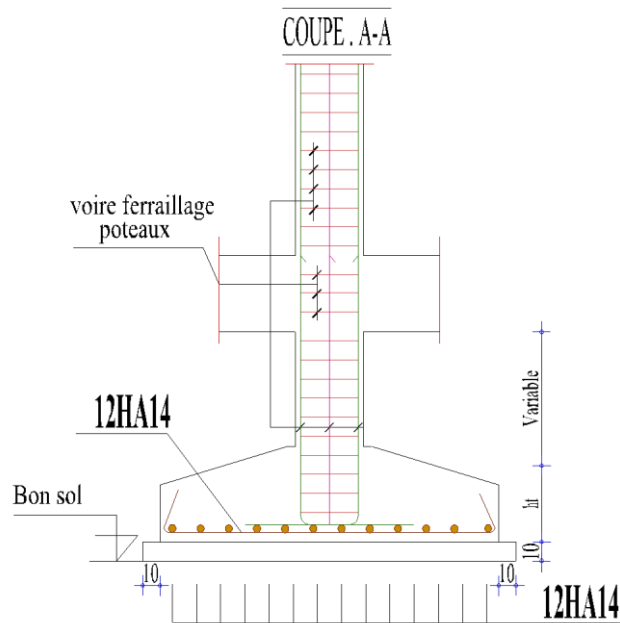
schéma de ferrailage semelle isolée sous poteau
